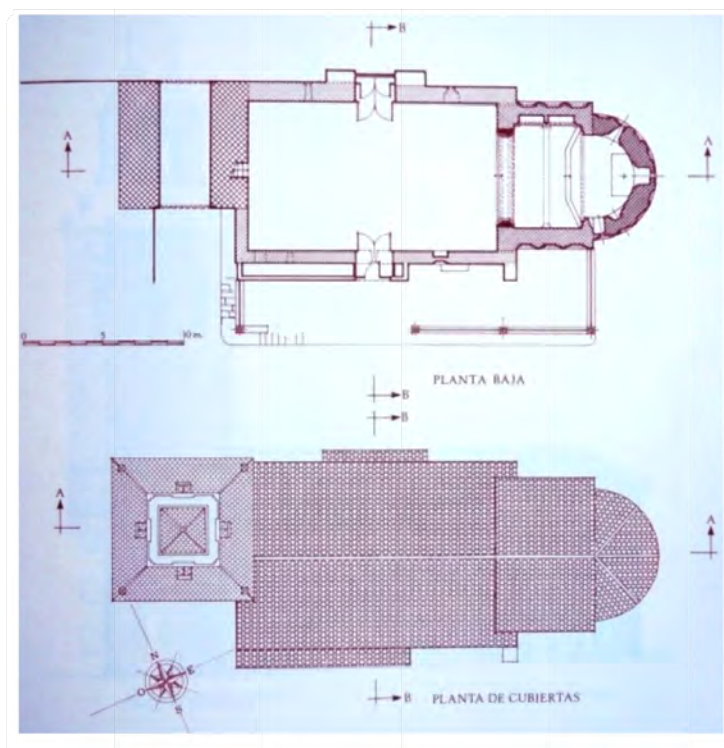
Planta baja y planta de cubiertas de Santa María la Mayor de Arévalo. Dibujo de Cervera Vera. Año 1992.
